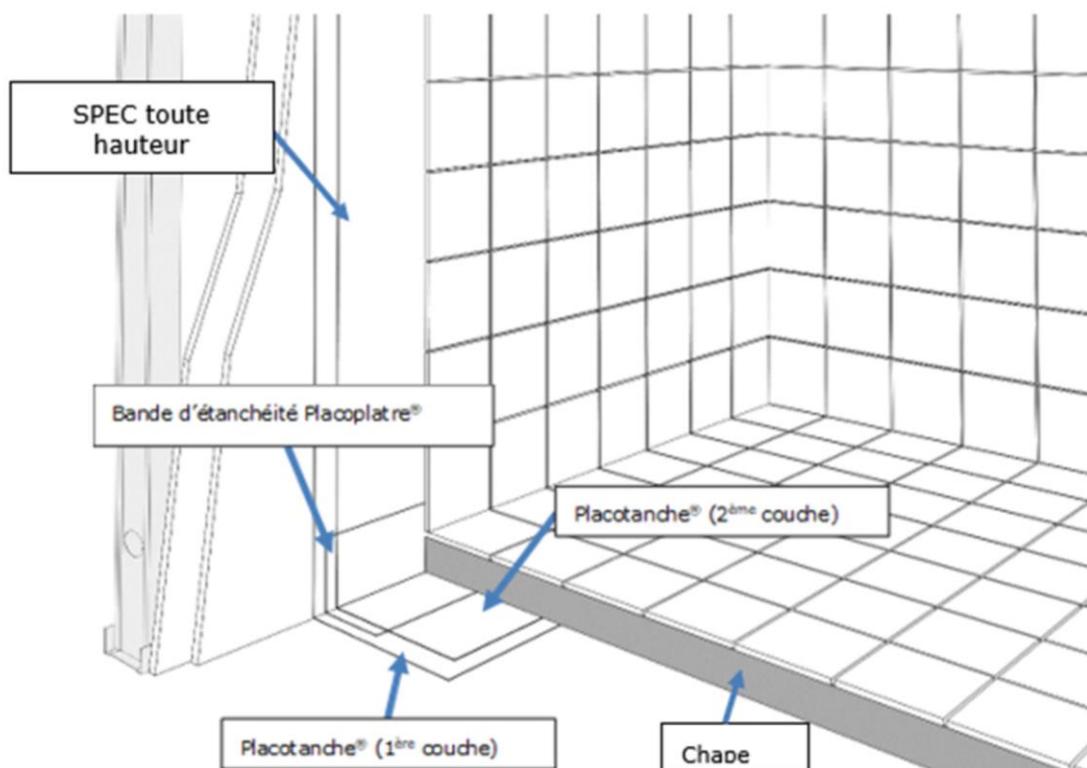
Locaux EB+ collectifs – Protection en pied de cloison (Cas de finition par carrelage collé)
